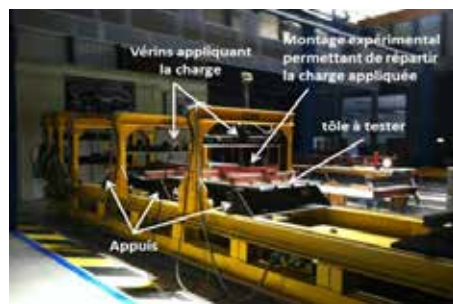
Essais de flexion sur structures à l'échelle 1 (Essais sur treillis)
